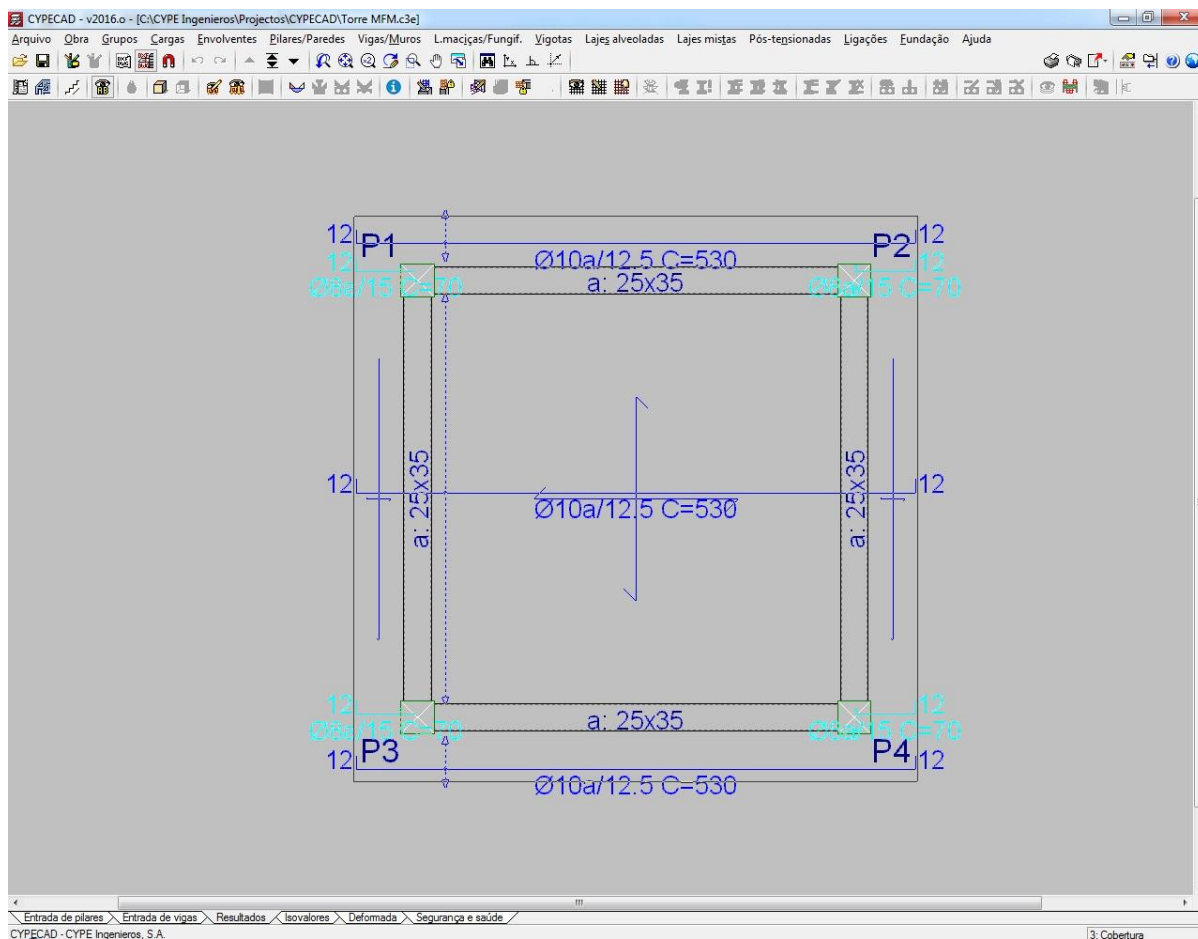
Resultados da estrutura com a laje apoiada nos pilares e nas vigas, em que já não há presença de esforços de punçoamento. (Fonte: Autor)
